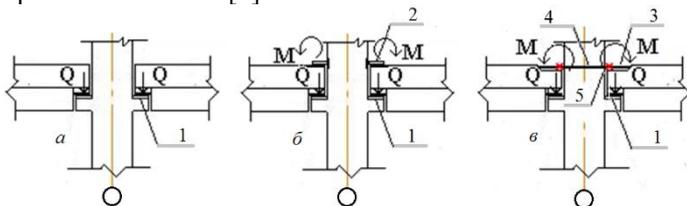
Виды стыков для многоэтажных каркасных зданий в сборном железобетоне (а, б, – шарнирные, в – жесткий): 1 – сварка закладных на консоли колонны, 2 – соединительная металлическая пластина для сопряжения закладной детали ригеля и колонны, 3 – арматурный стержень-выпуск из ригеля, 4 – арматурный стержень-выпуск из колонны, 5 – сварка арматурных выпусков
